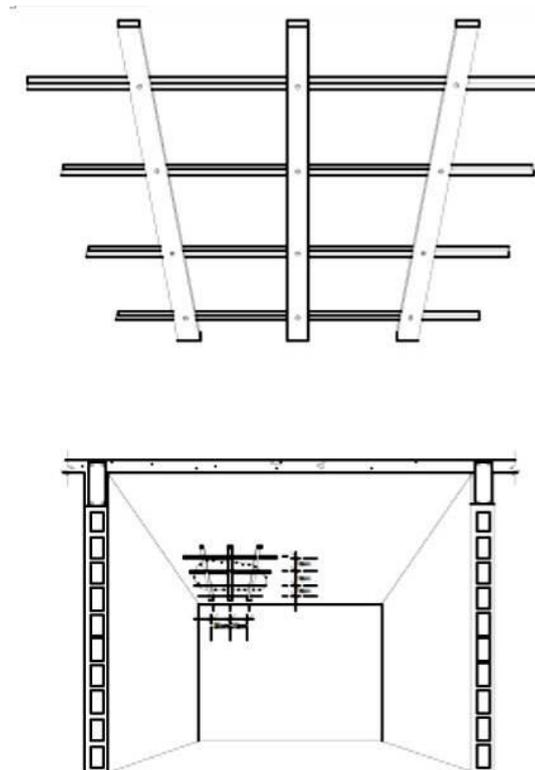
Detalhe de fixação dos perfis metálicos na laje.
